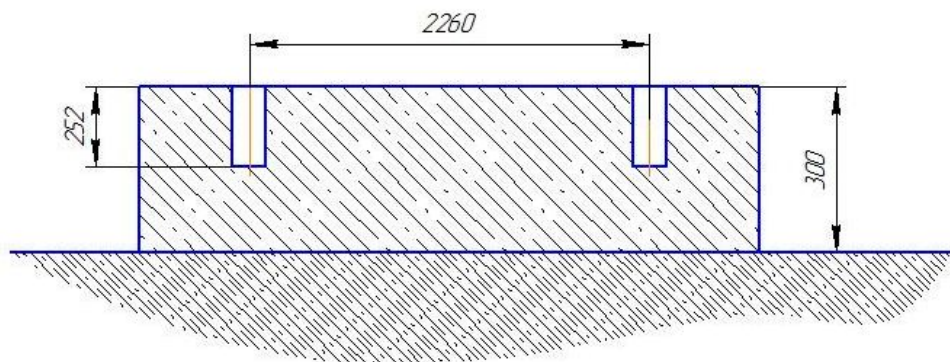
План фундаментной площадки под модернизированный гидроциклонный чан
